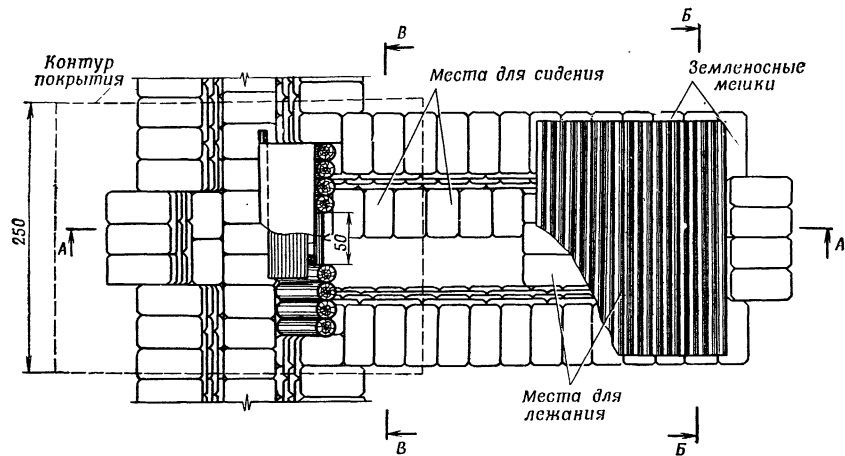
Блиндаж из БЗМ-57 и круглого леса (план, разрез)
